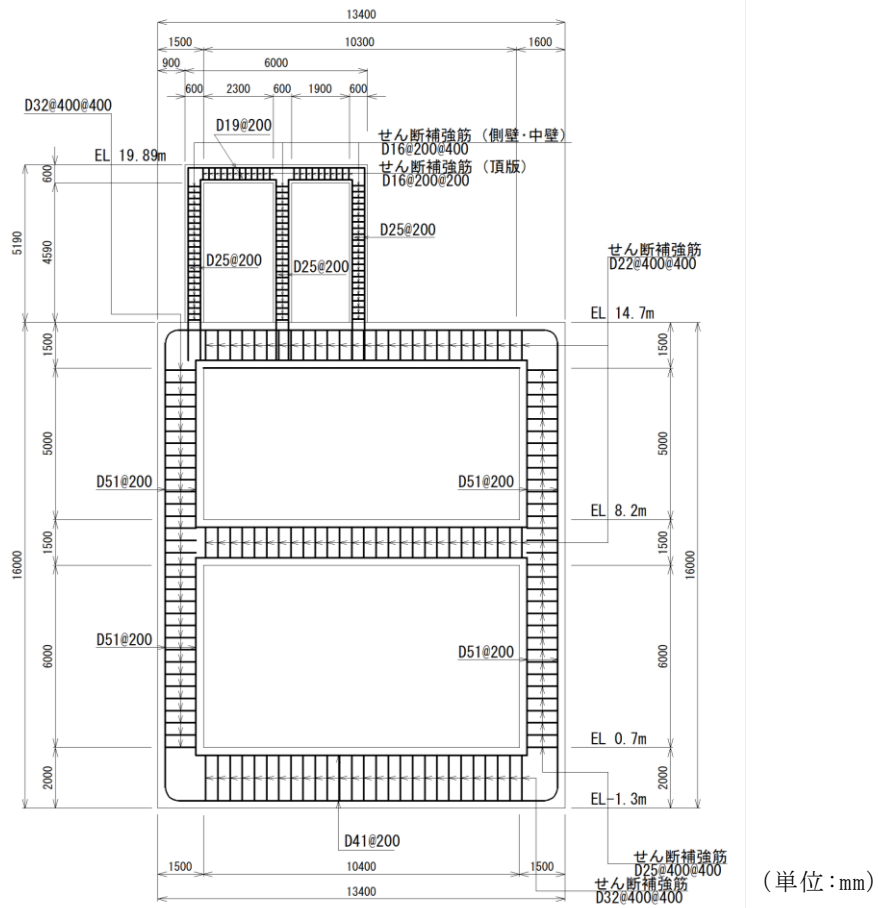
低圧原子炉代替注水ポンプ格納槽 概略配筋図 (E-E 断面)
